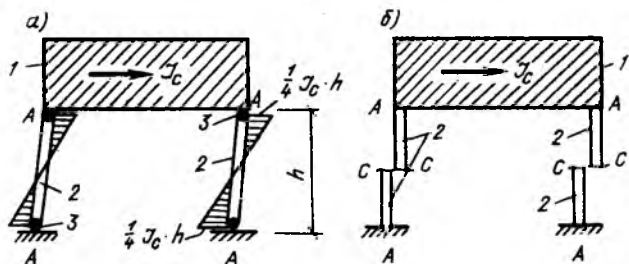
Расчетная схема (а) и схема разрушения (б) здания с гибким 1-м этажом 1 — жесткий диск верхних этажей; 2 — колонны; 3 — пластические шарниры в колоннах от изгиба
